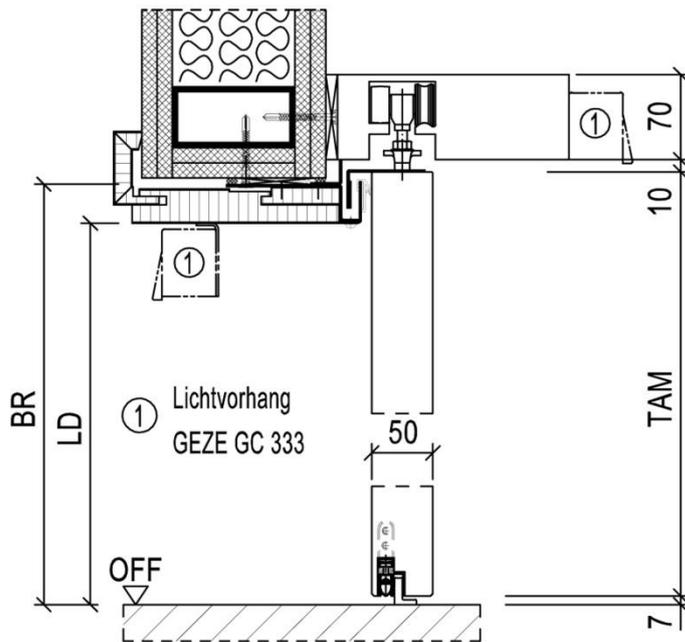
Drei-schalige Holzzarge zur Hinterfüllung mit PU-Schaum oder Mineralwolle für den Einbau der Brandschutz-Schiebetüren in Leichtbauwände.
